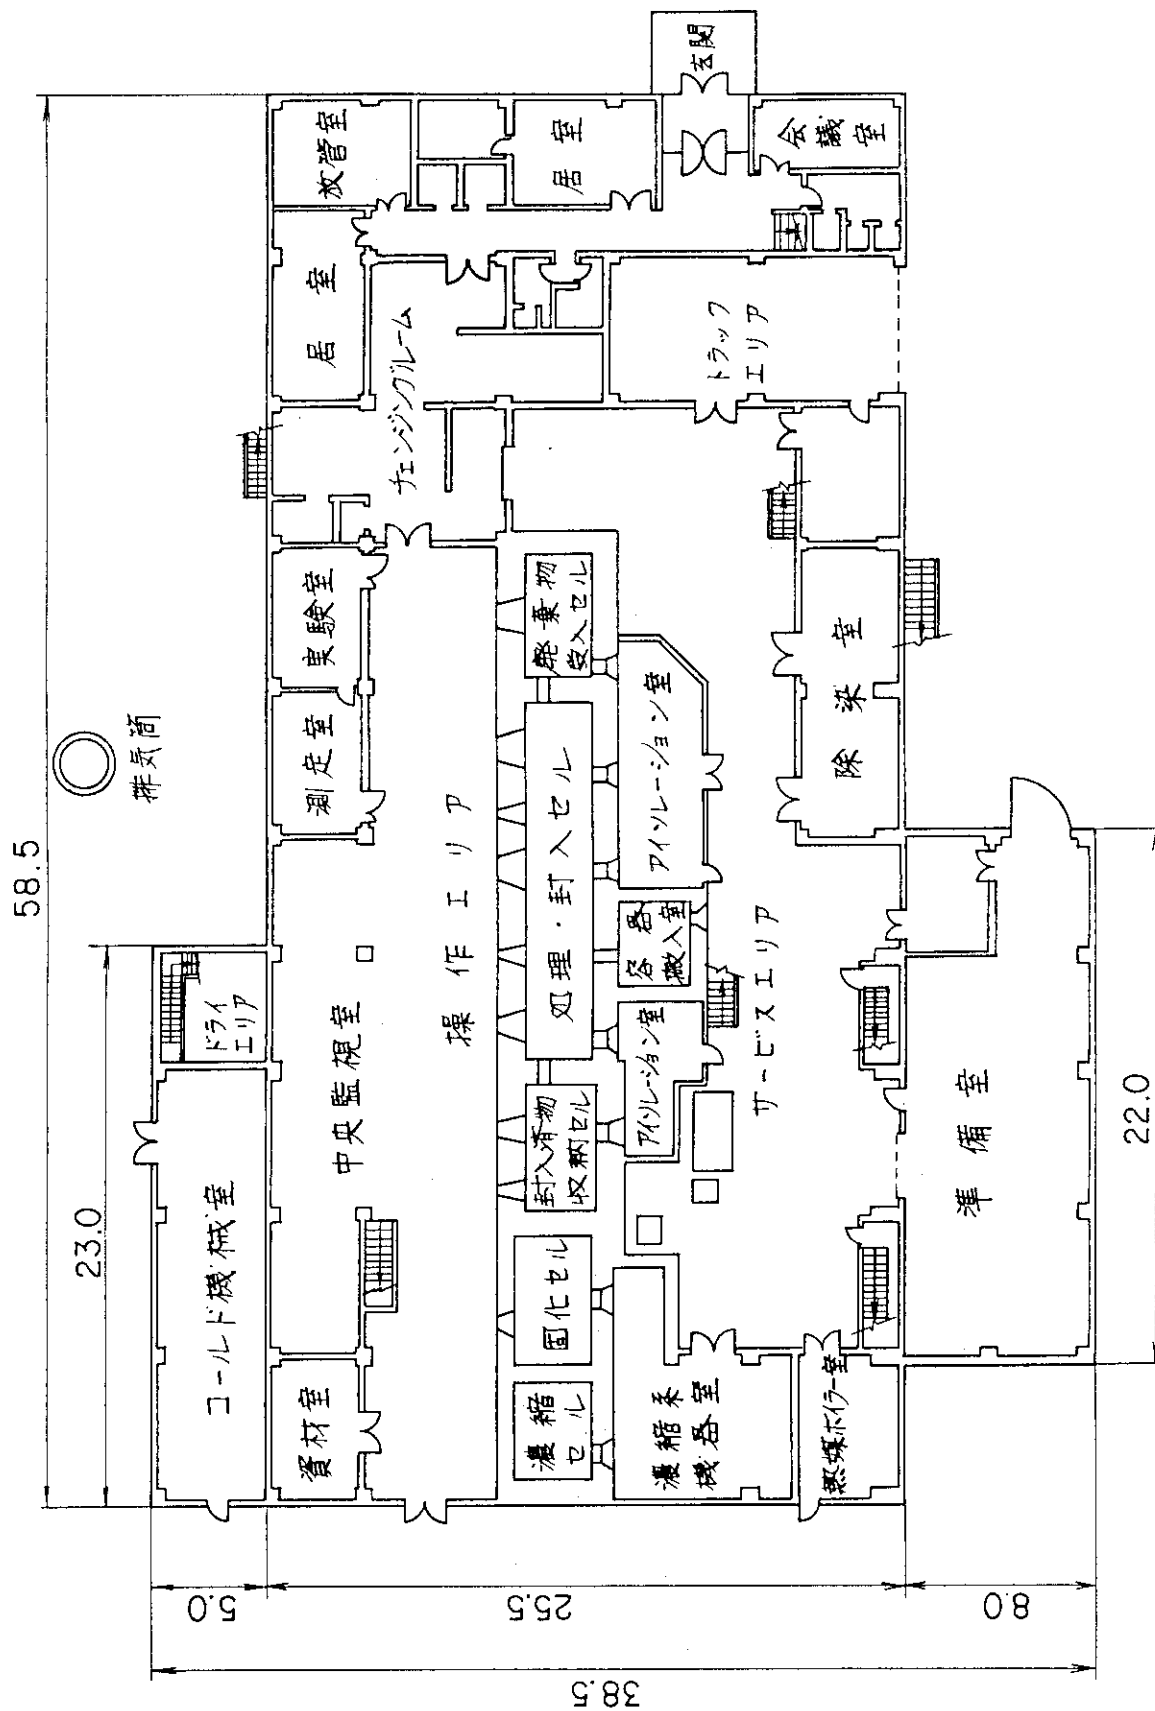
第2廃棄物処理棟1階平面図 (単位: m)
